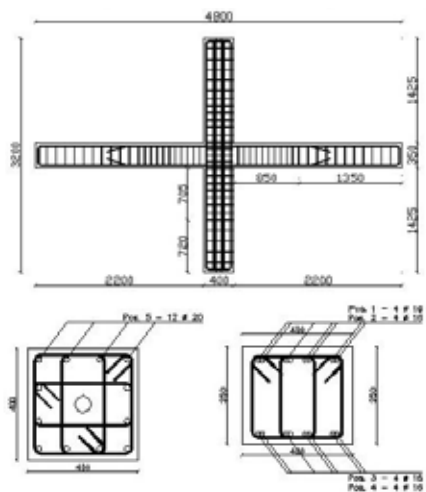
Vista laterale e sezioni di pilastro e trave del nodo N. 1.
